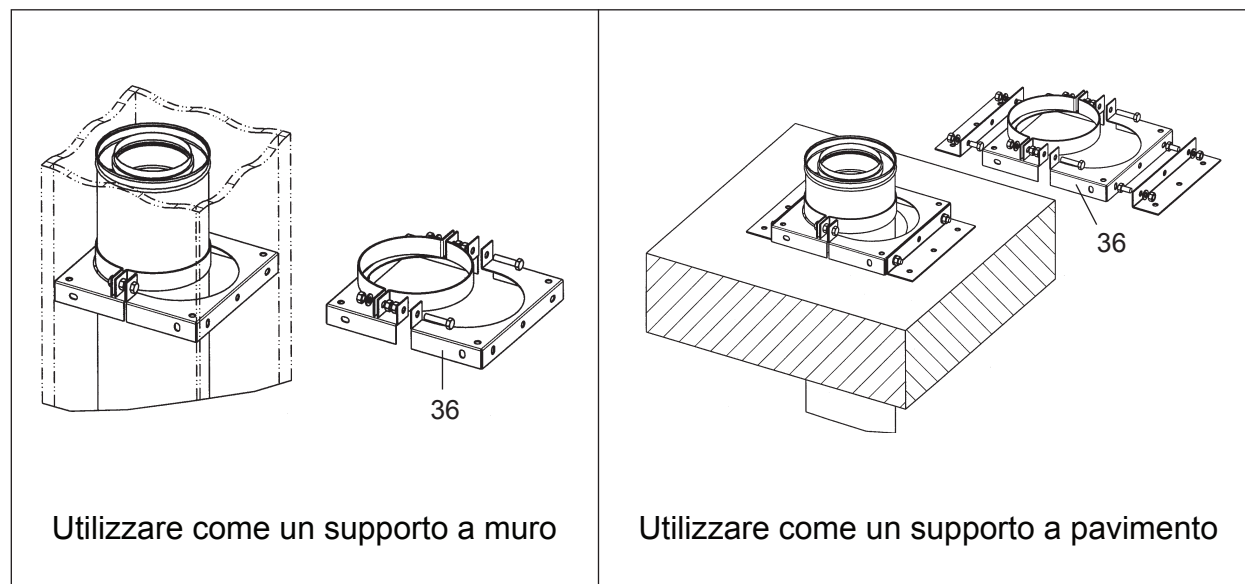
Applicazione supporto universale muro/pavimento Ø150 mm
